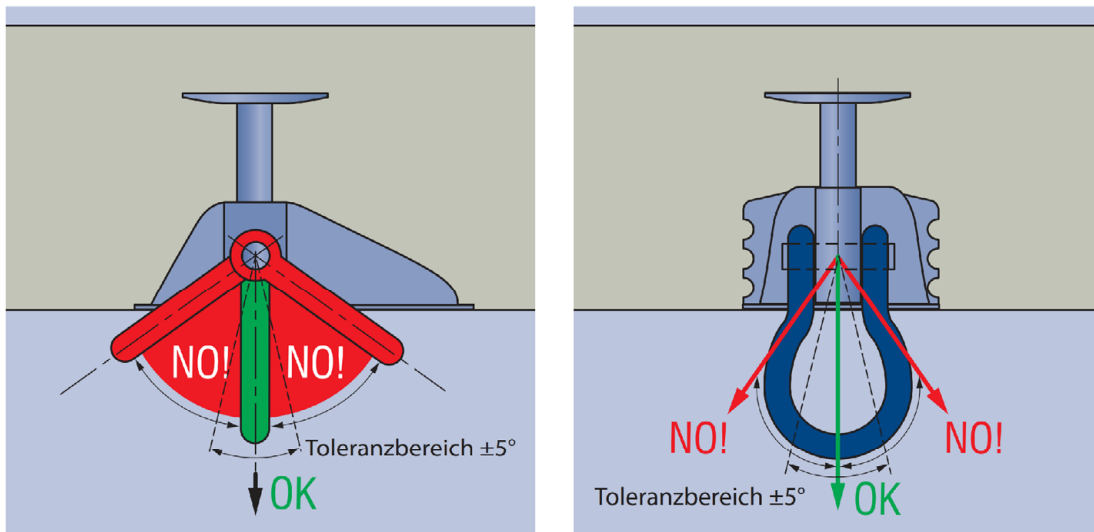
Planmäßige Belastungsrichtung ¹⁾
